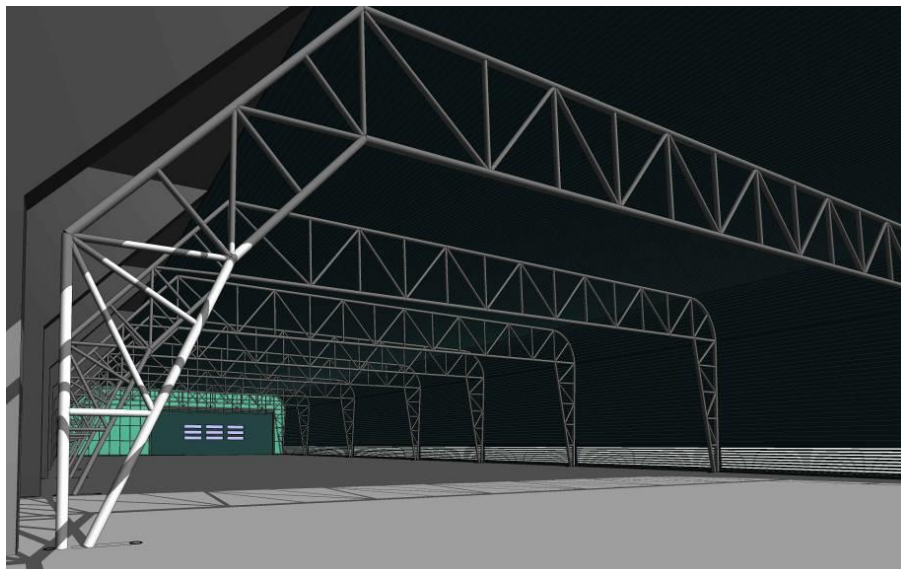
Struttura di acciaio dell'Avanfossa con il piazzale per il conferimento
